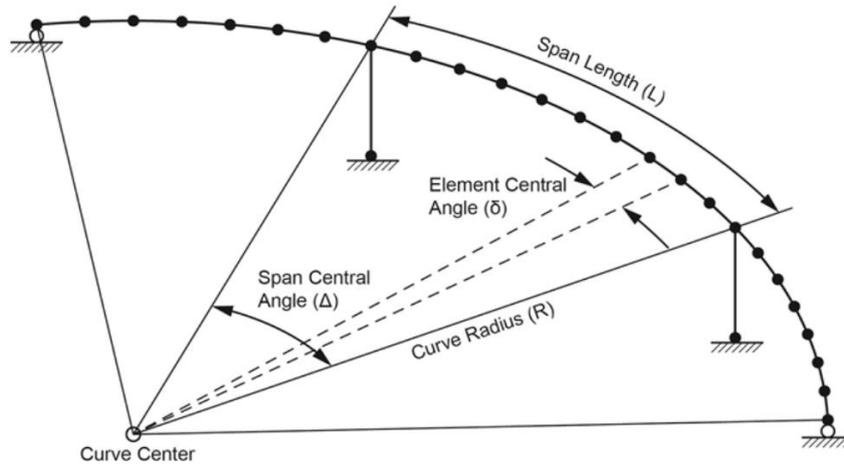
Esquema estrutural adotado para o viaduto OAE 9ª
